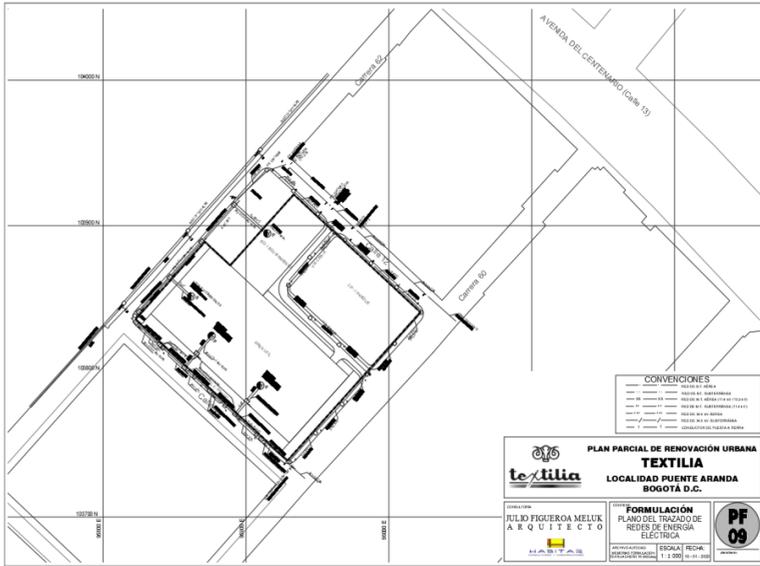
PF 09. Trazado de Redes de Energía Eléctrica
